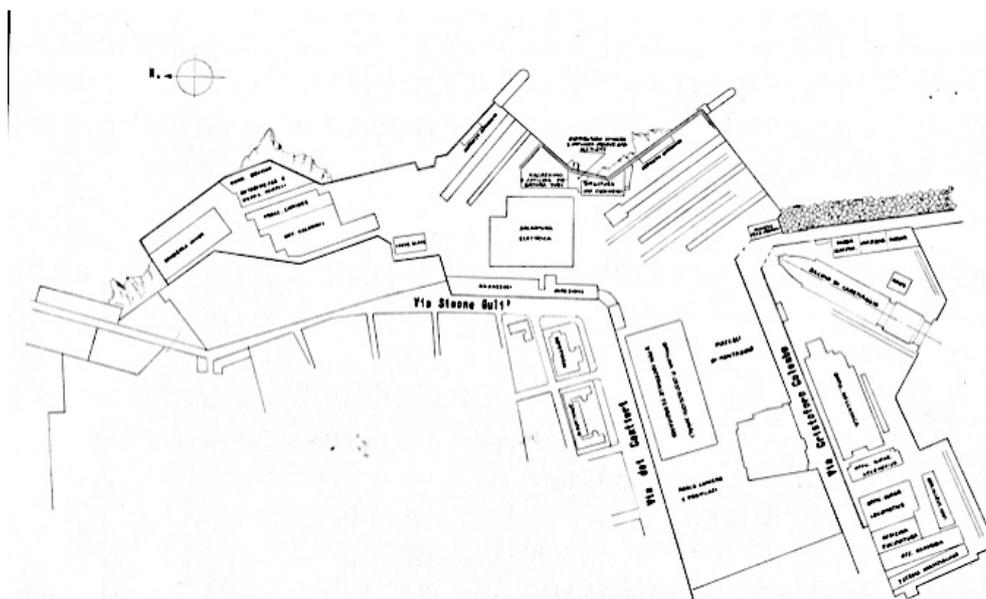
C.N.R. «Planimetria del cantiere dopo l'ampliamento» Palermo 11/1/1952. Fonte AFPa
